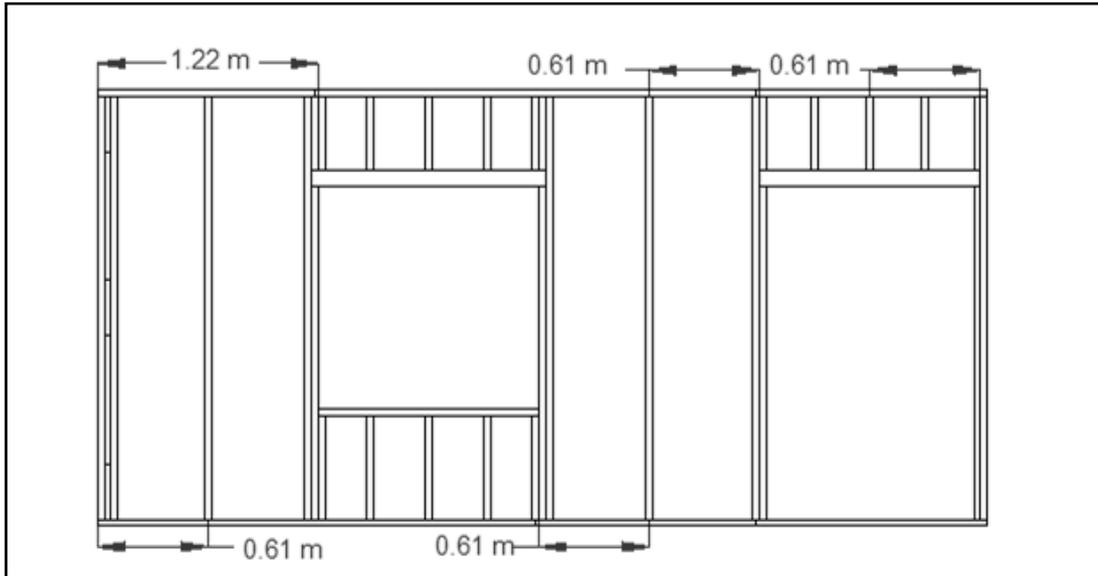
Separación de pies derechos a cada 61 cm (24") entre centros para la colocación de tableros contrachapados (1.22 x 2.44 m).
